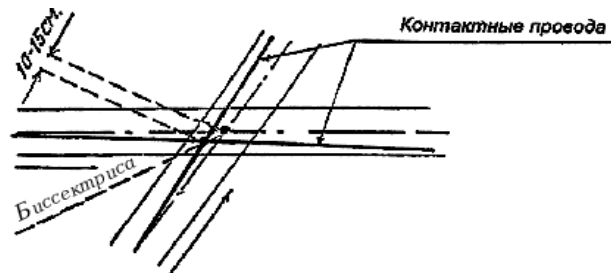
Схема размещения воздушной крестовины на пересечении трамвайных путей
